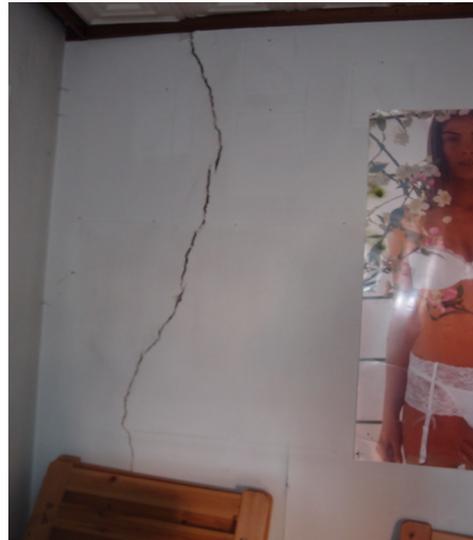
1. Obergeschoss, bedenklicher Riss
